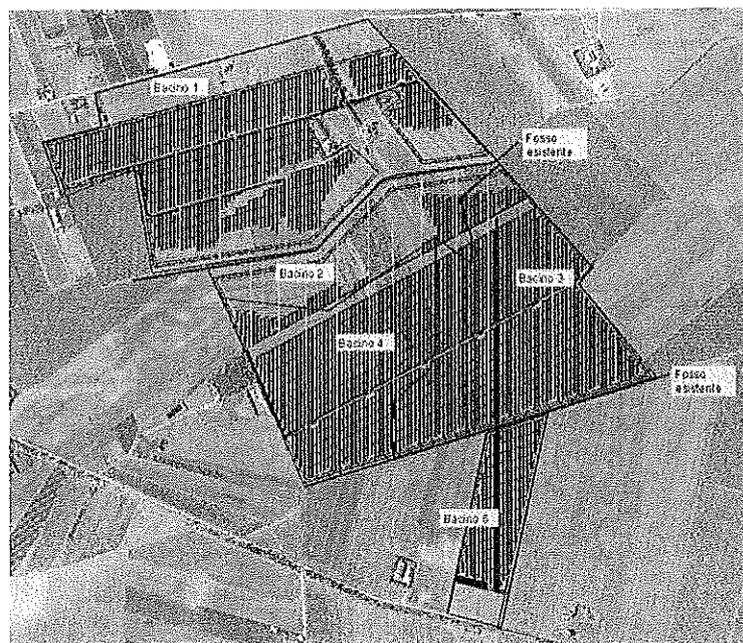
Delimitazione aree di impianto e codifica Allegati I planimetria acque meteoriche
